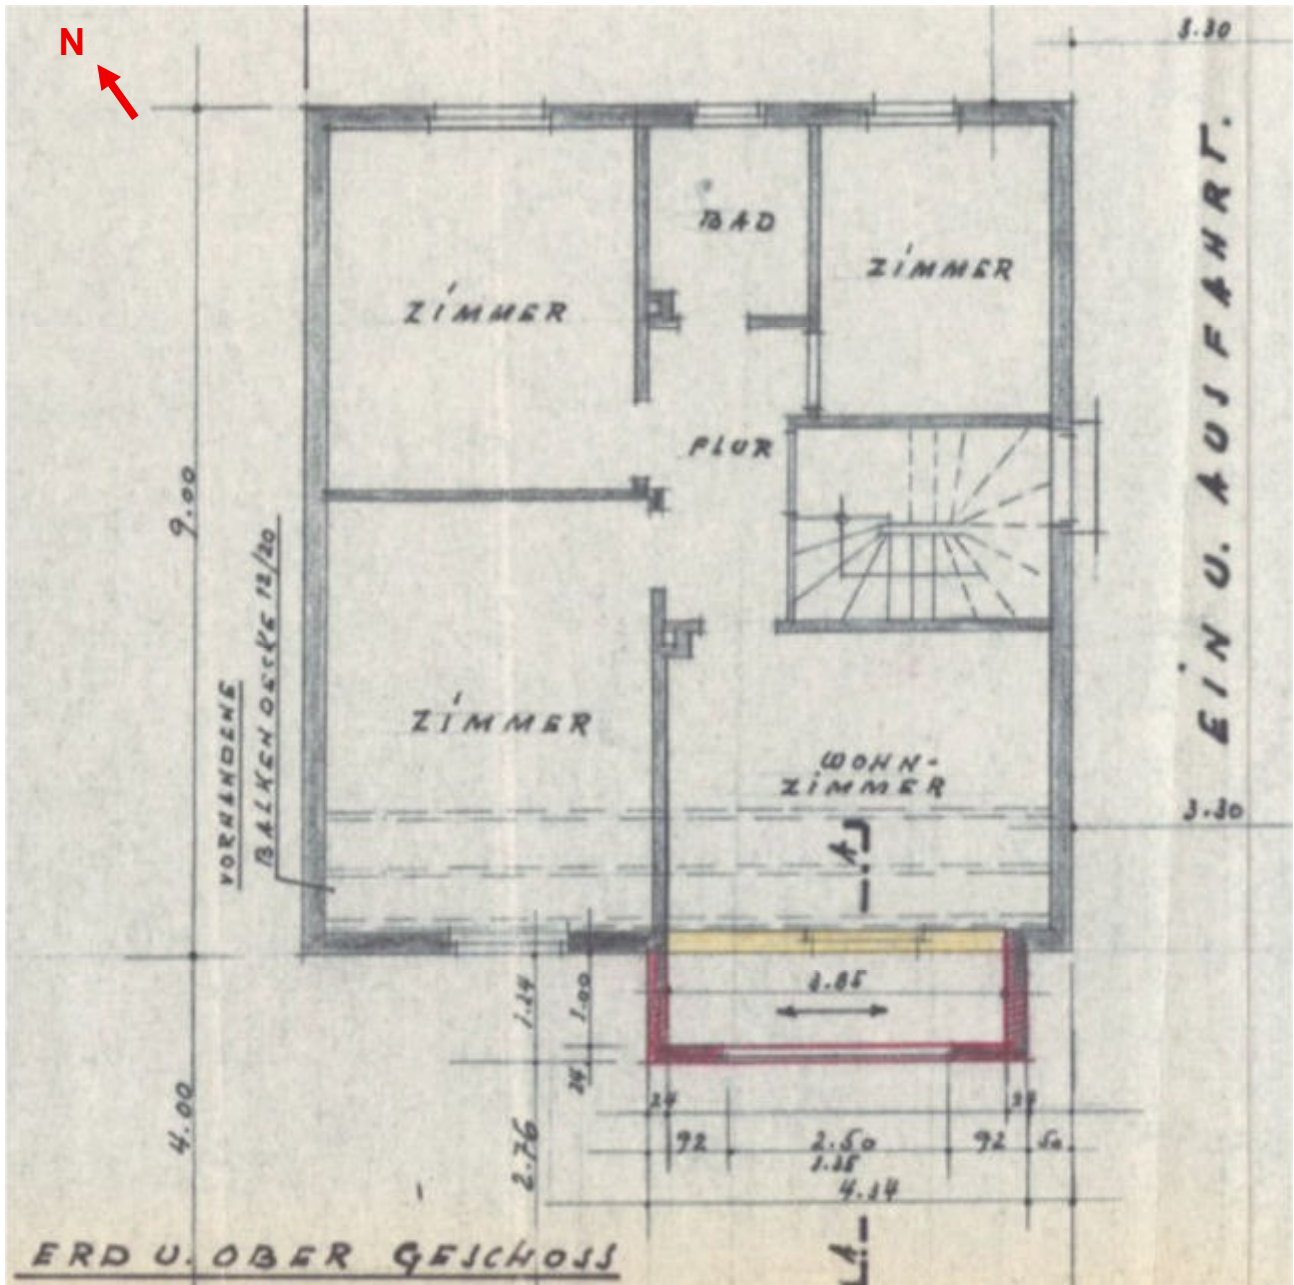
Grundriss Erd- und Obergeschoss (ohne Maßstab) 1965; Quelle: Bauakte Errichtung einer Garage und eines Erkers; Nordpfeil d.d. SV
